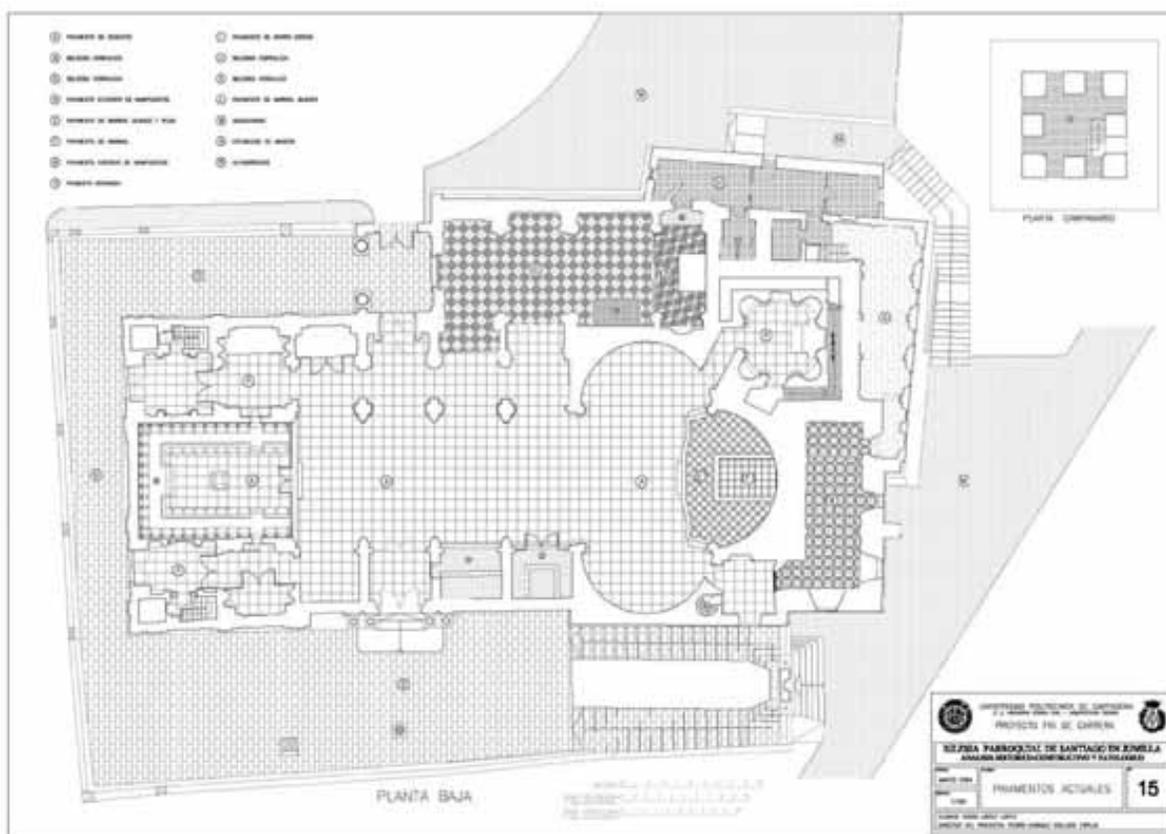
Plano de planta realizado para el TFC donde se graficaron los pavimentos existentes en el templo identificando materiales.
